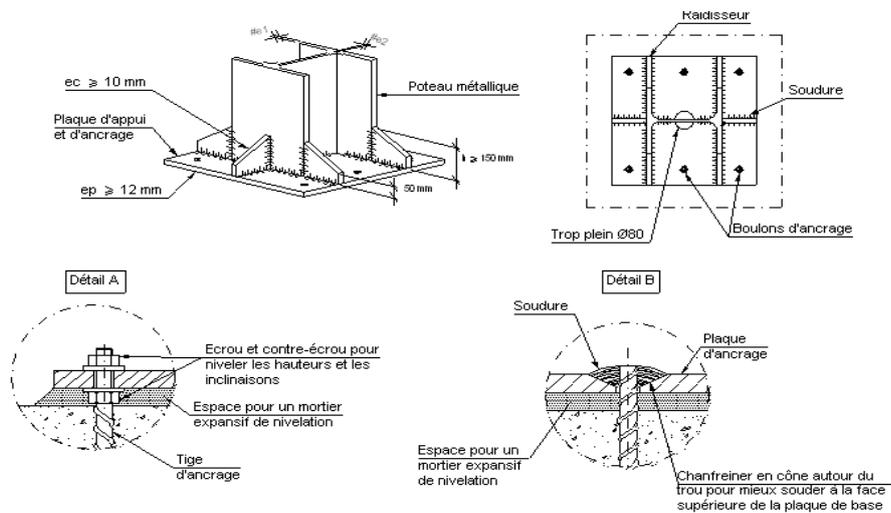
Détails technique de l'encastrement d'un poteau métallique
